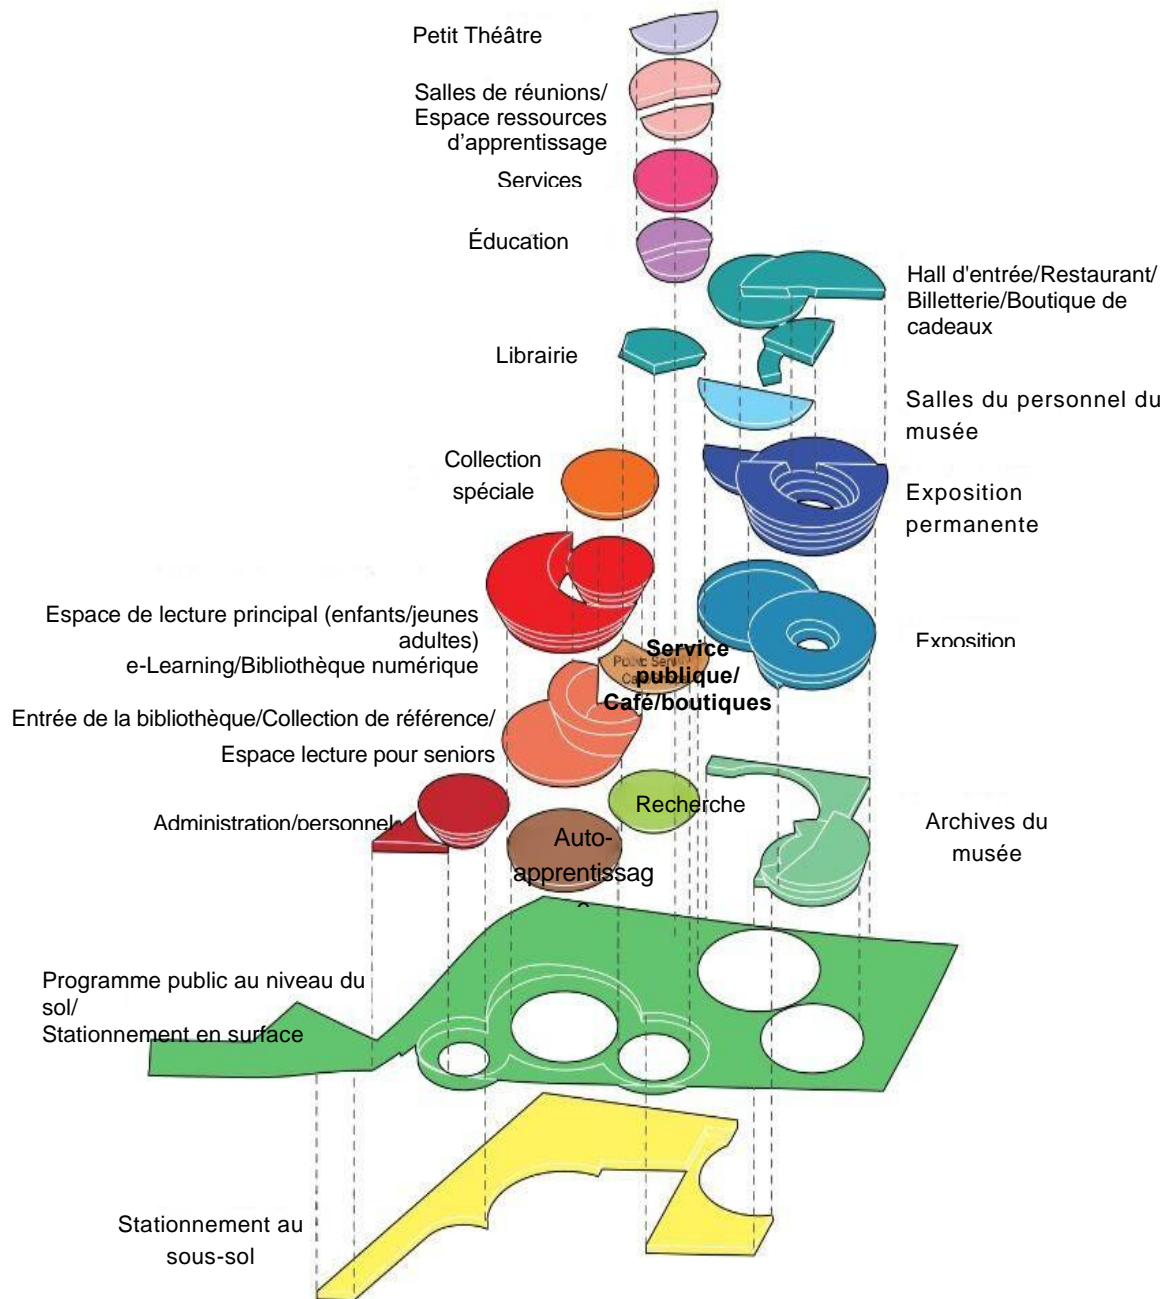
Plan du projet du centre culturel de la ville Taichung
